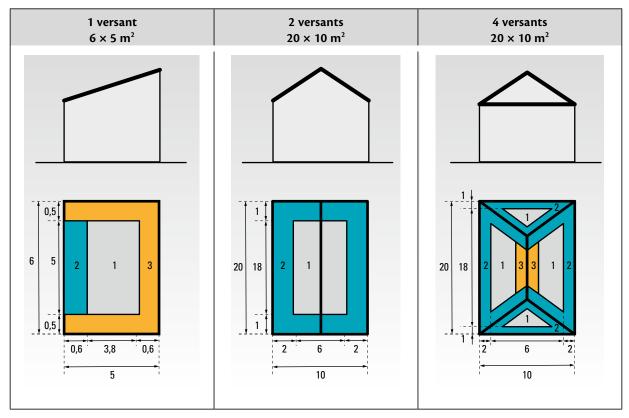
Exemples de dimensions des zones de toiture selon le nombre de versants (projection sur le plan horizontal et non pas sur le plan des versants)
